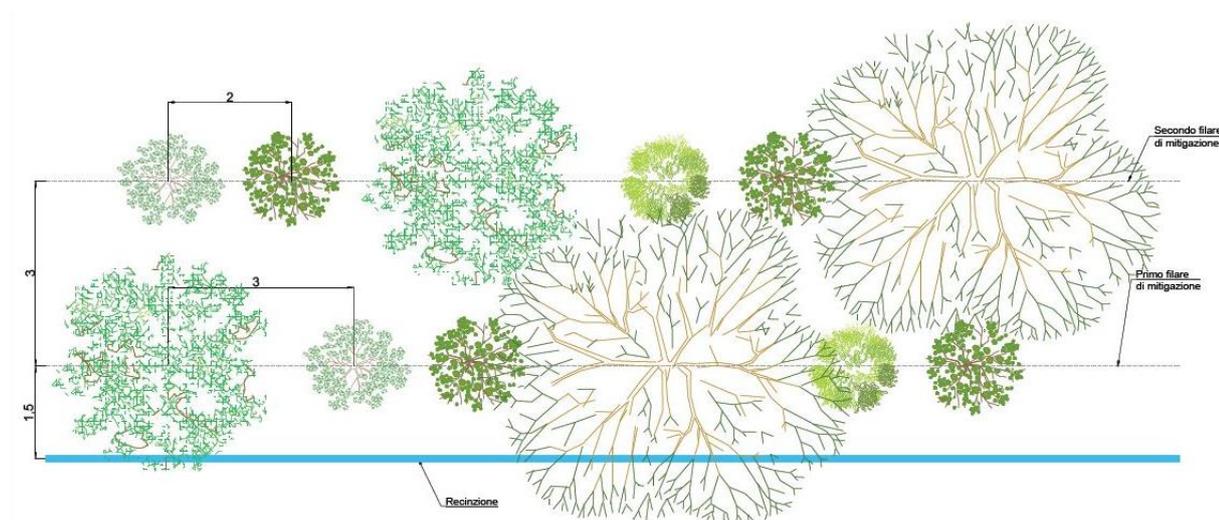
Pianta della barriera di mitigazione posta all'esterno della recinzione perimetrale dell'impianto (schema della piantumazione)
